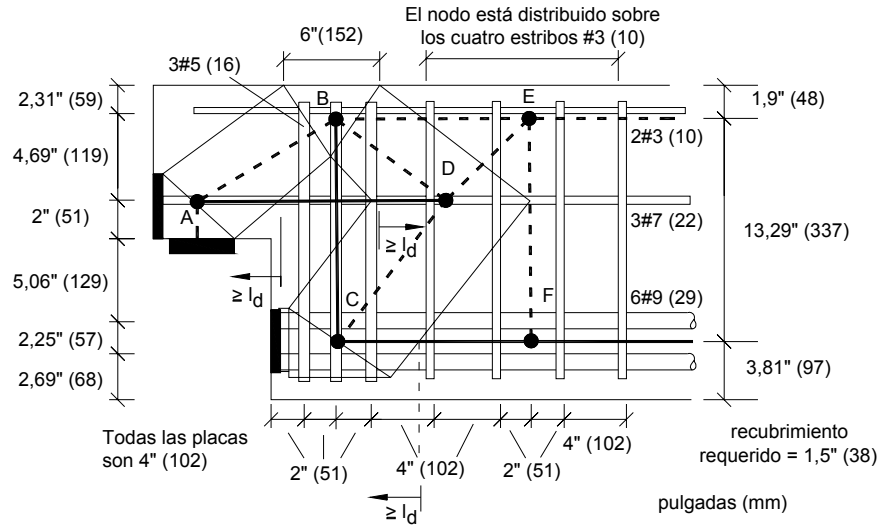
Detalles de las bielas y tirantes con la armadura propuesta
